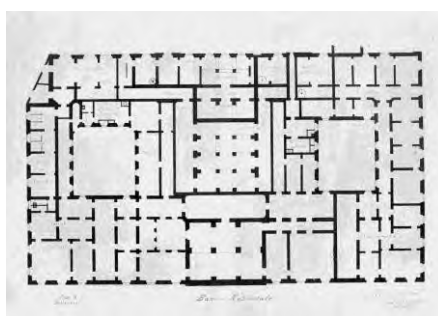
progetto Piacentini Banca d'Italia pianta sotterranei
